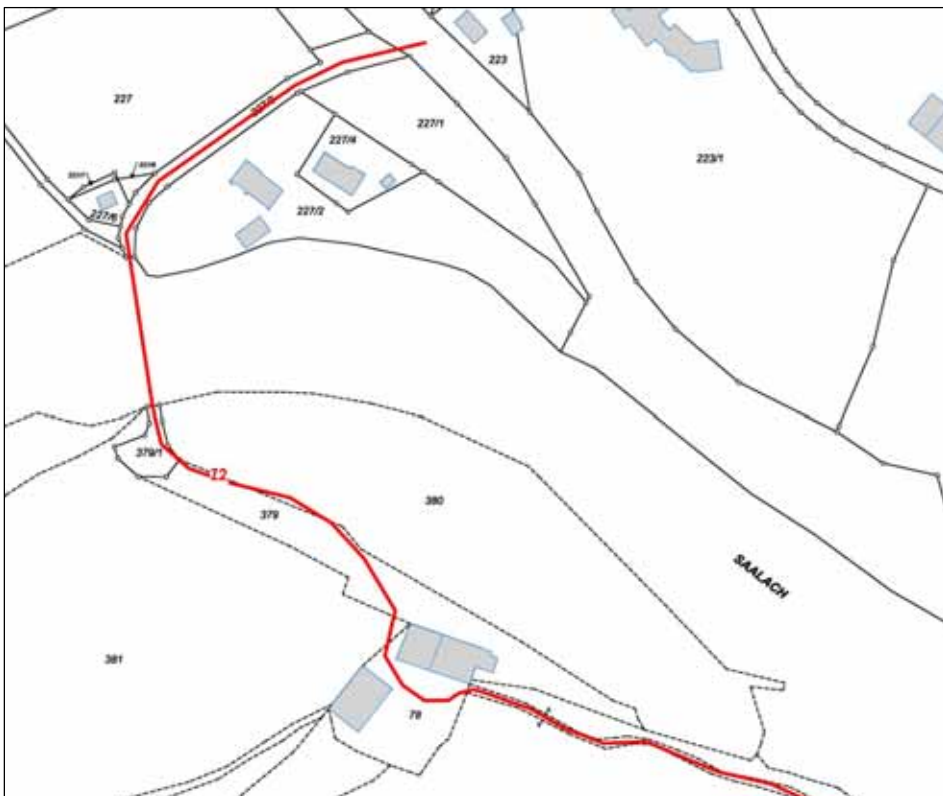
Lageplan mit Darstellung der Schallquelle für die Zufahrt zum Wasserschloss V5
